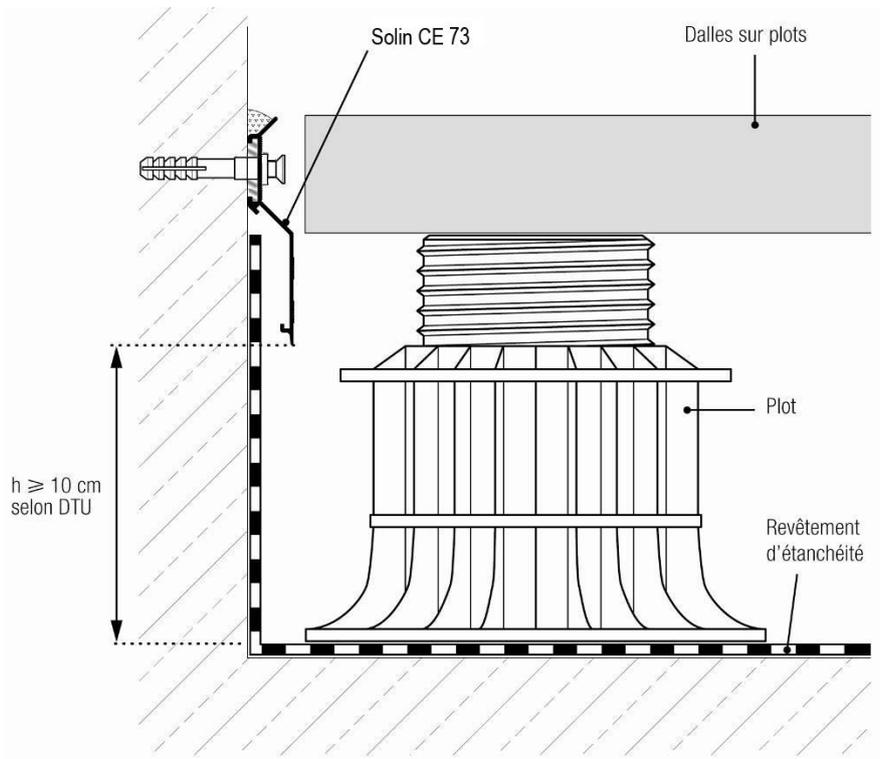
Toiture-terrasse accessible aux piétons et au séjour avec dalles sur plots et niveau fini des dalles au-dessus du haut des relevés
